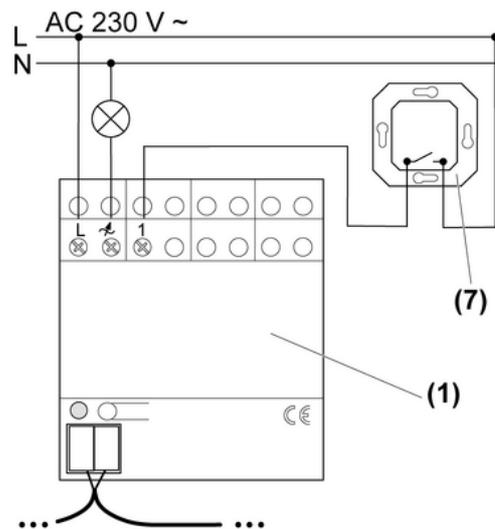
Raccordement d'un poussoir d'installation éteint (7)
